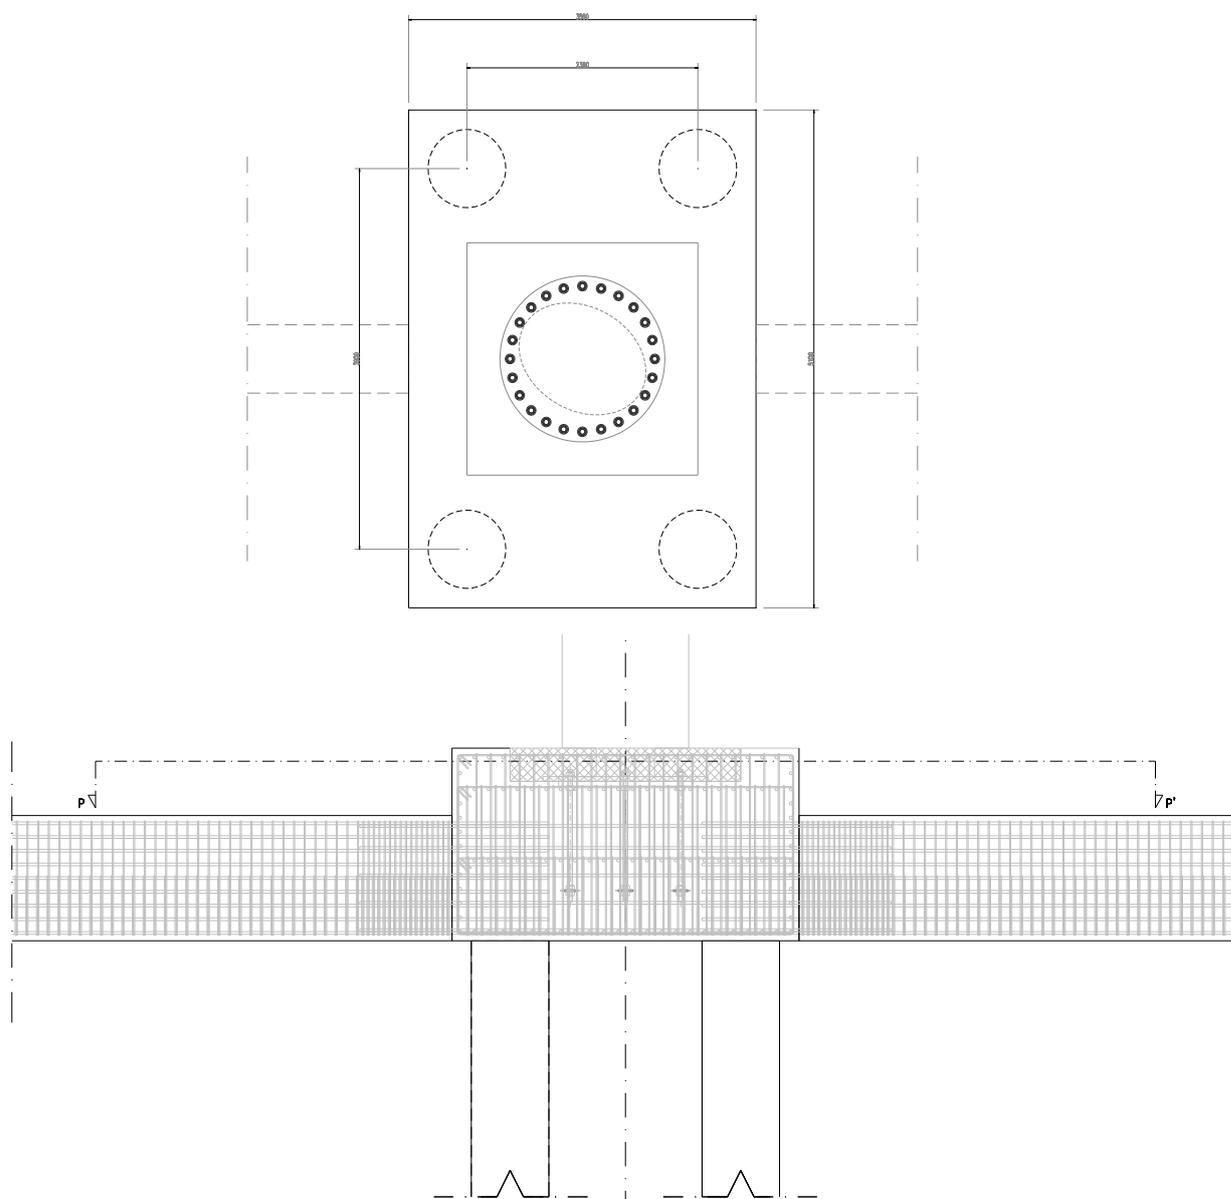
Viste schematiche in sezione e in pianta del plinto su pali con trave di collegamento
